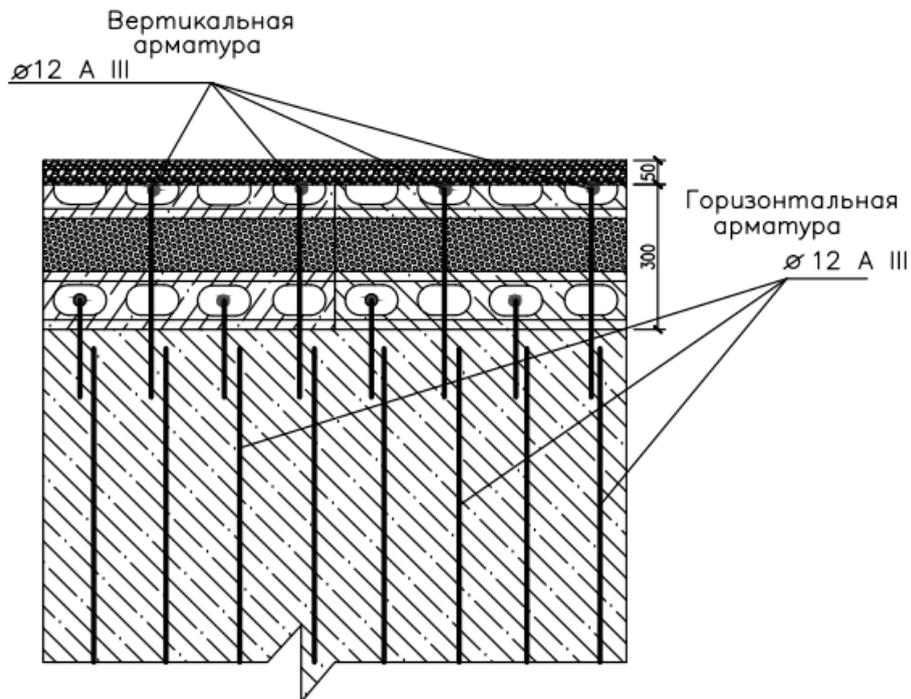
Схема армирования стыков плиты перекрытия с ограждающими стенами
